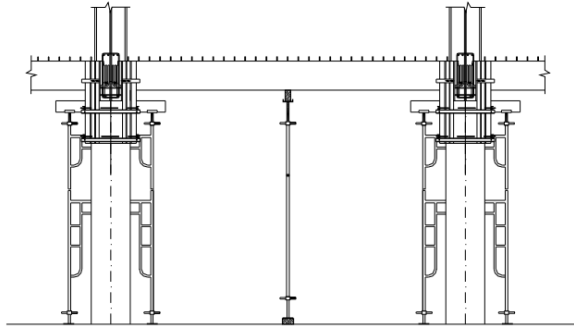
3 Detail Sambungan Kolom- Kolom dan Kolom – Balok
